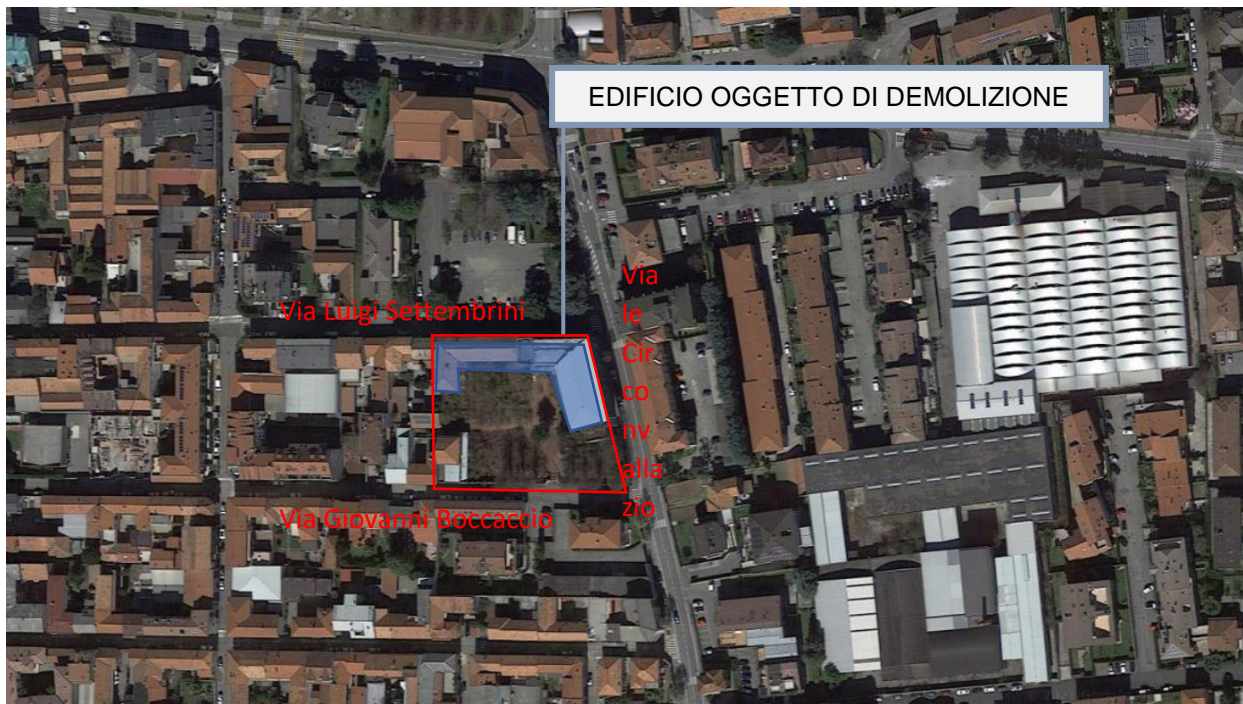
Stralcio ortofoto con individuazione edificio da demolire
